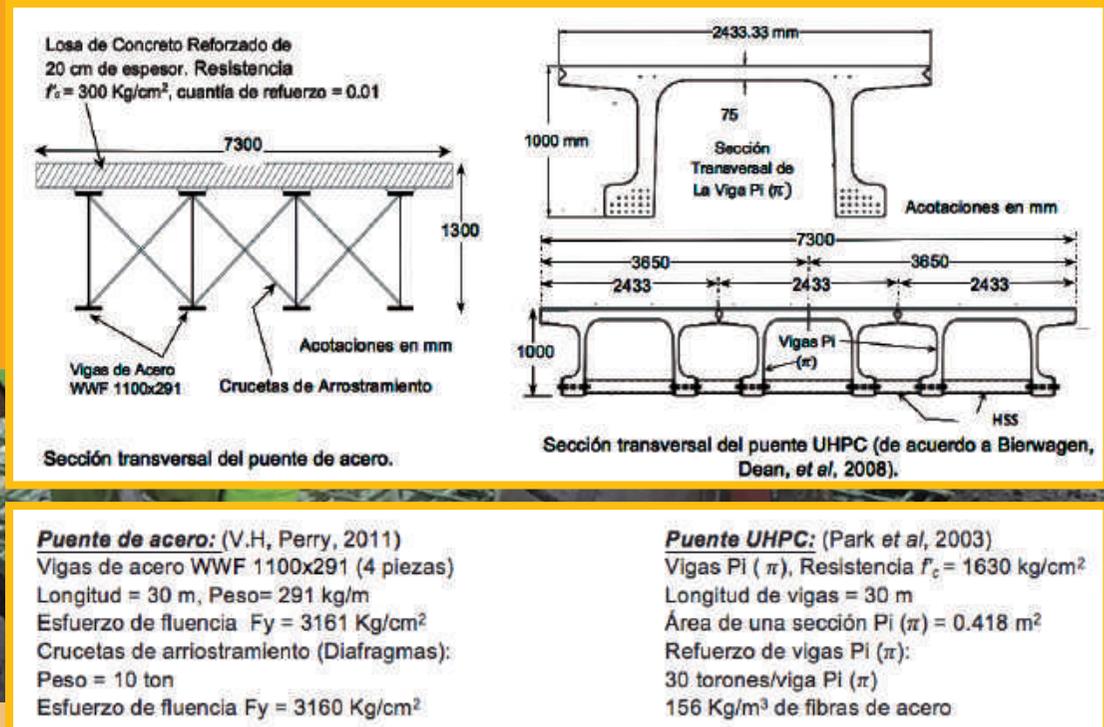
Sección transversal de puente de acero con losa in situ de concreto reforzado contra puente de concreto presforzado con vigas prefabricadas tipo Pi (π) utilizando UHPC.
